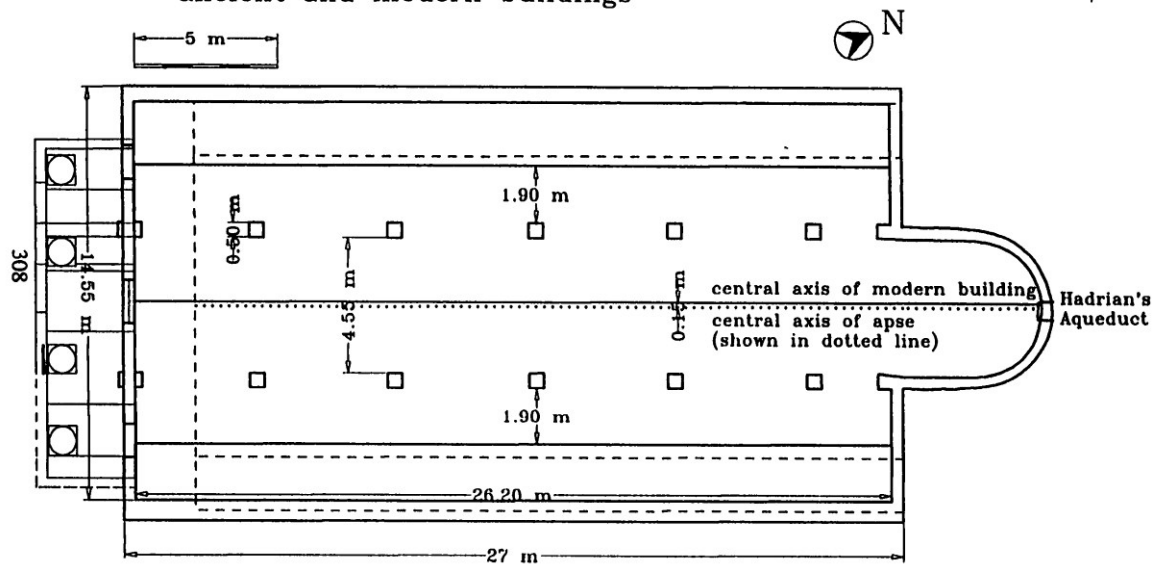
Athen – Hadrians-Reservoir Grundriss
